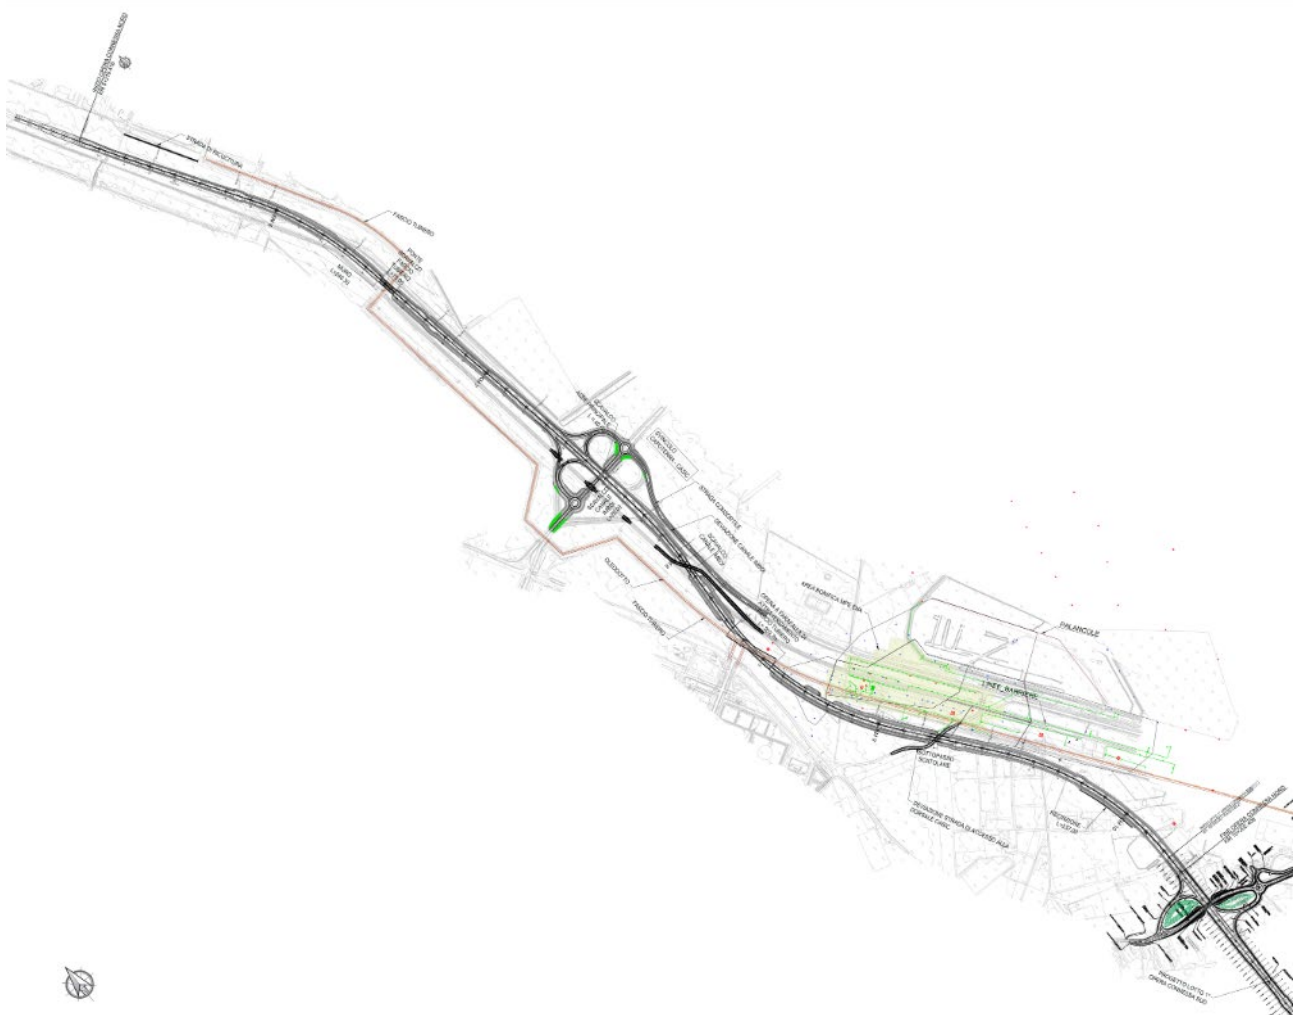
Stralcio Planimetria d'insieme *Opera Connessa Nord
